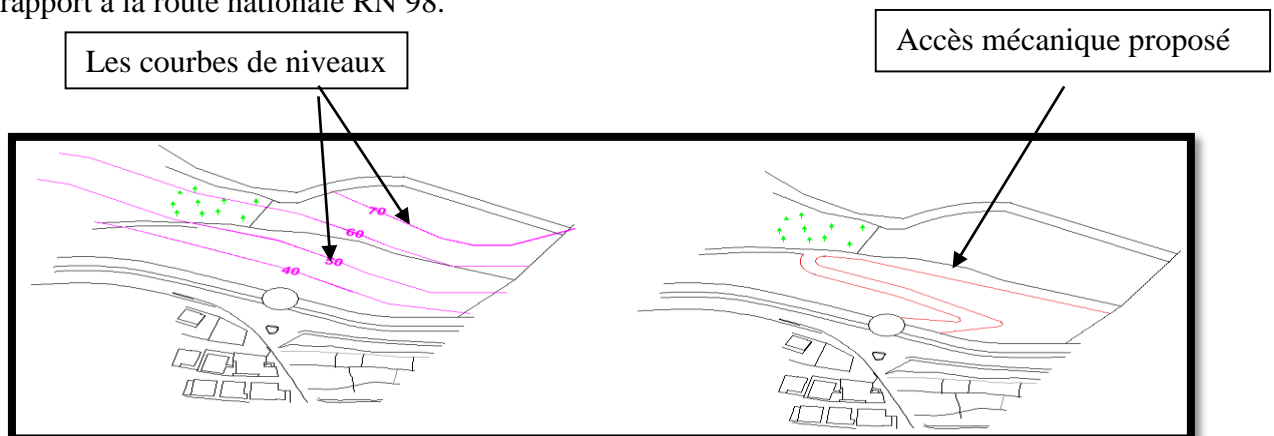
plan de l'accès mécanique proposé. (Source l'auteur)
